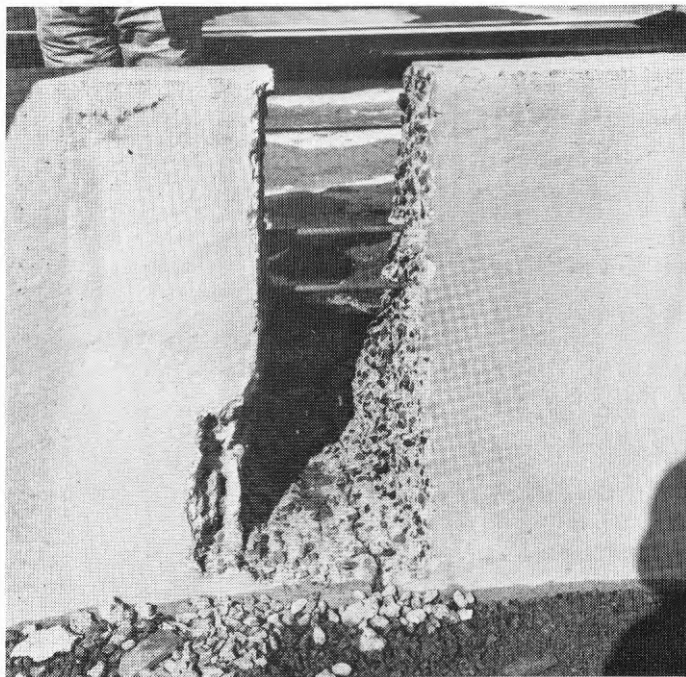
Vattenbilat snitt genom betongbarriär.
